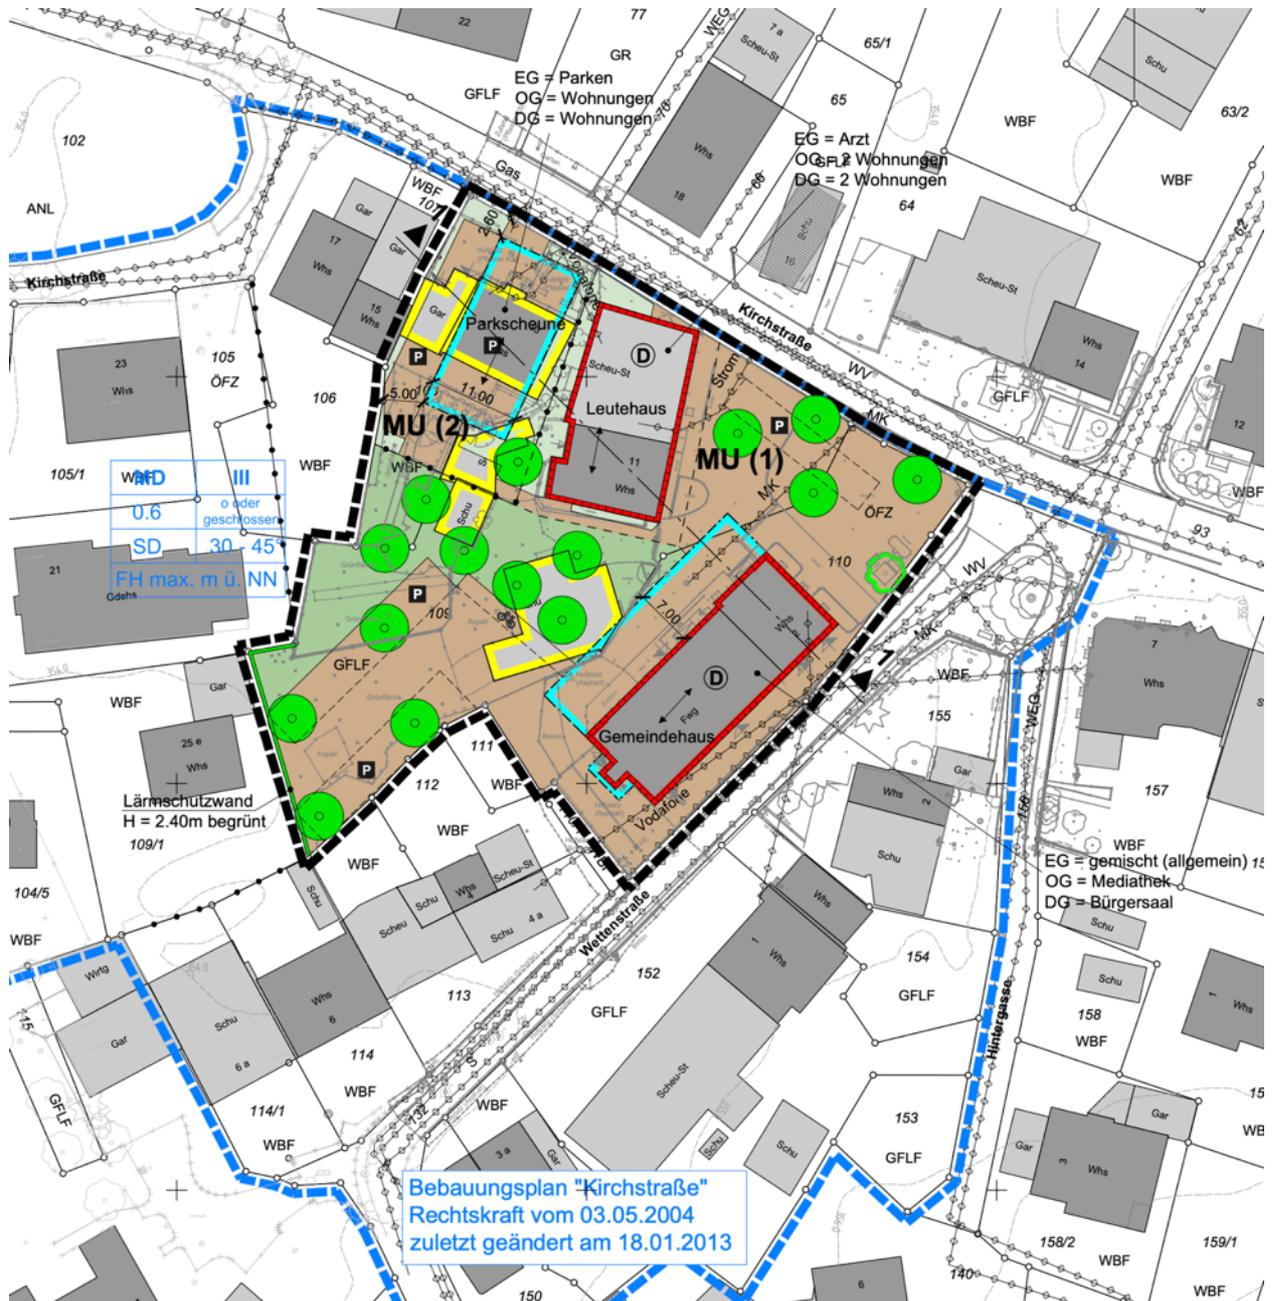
Ausschnitt Entwurfsplan B-Plan „Lindenplatz“
